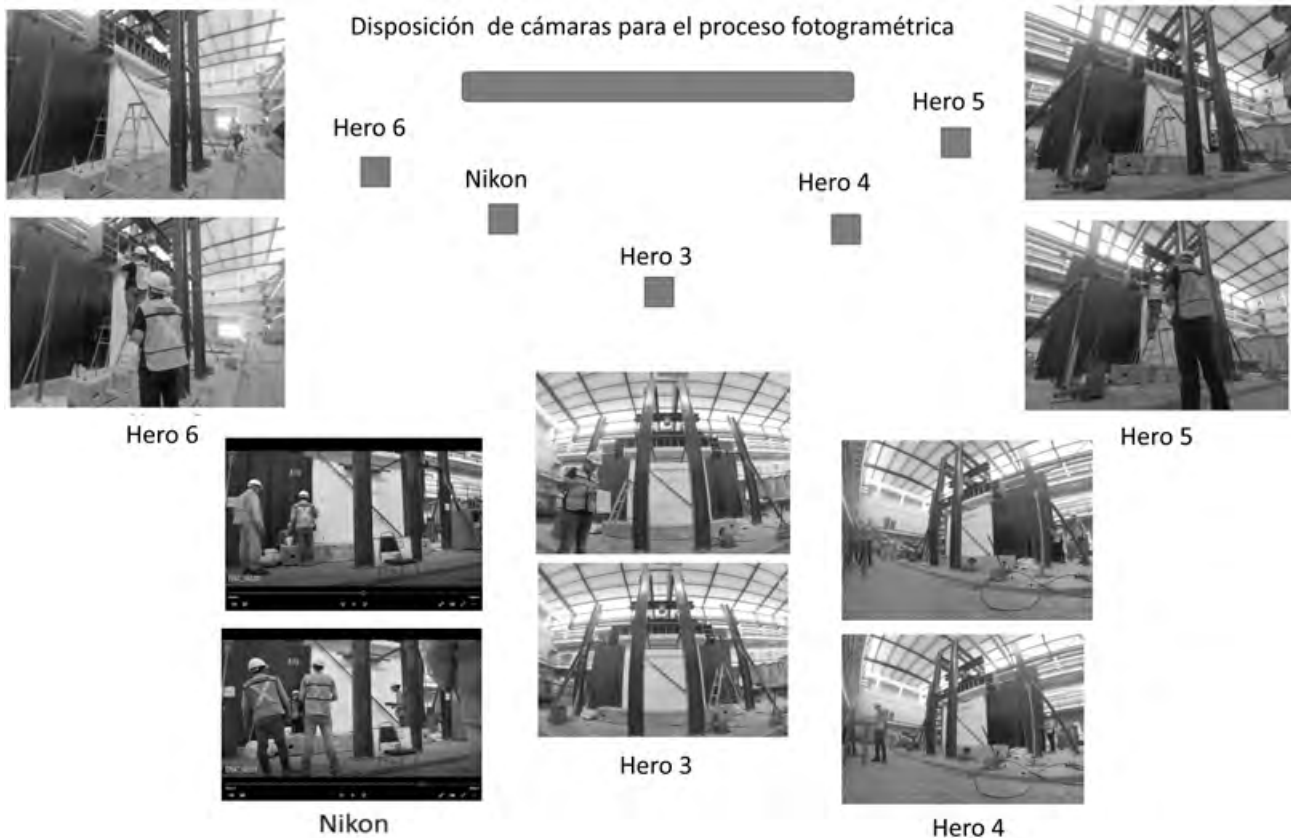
Control fotogramétrico del comportamiento de un muro de mampostería ensayado a carga cíclica reversible.
